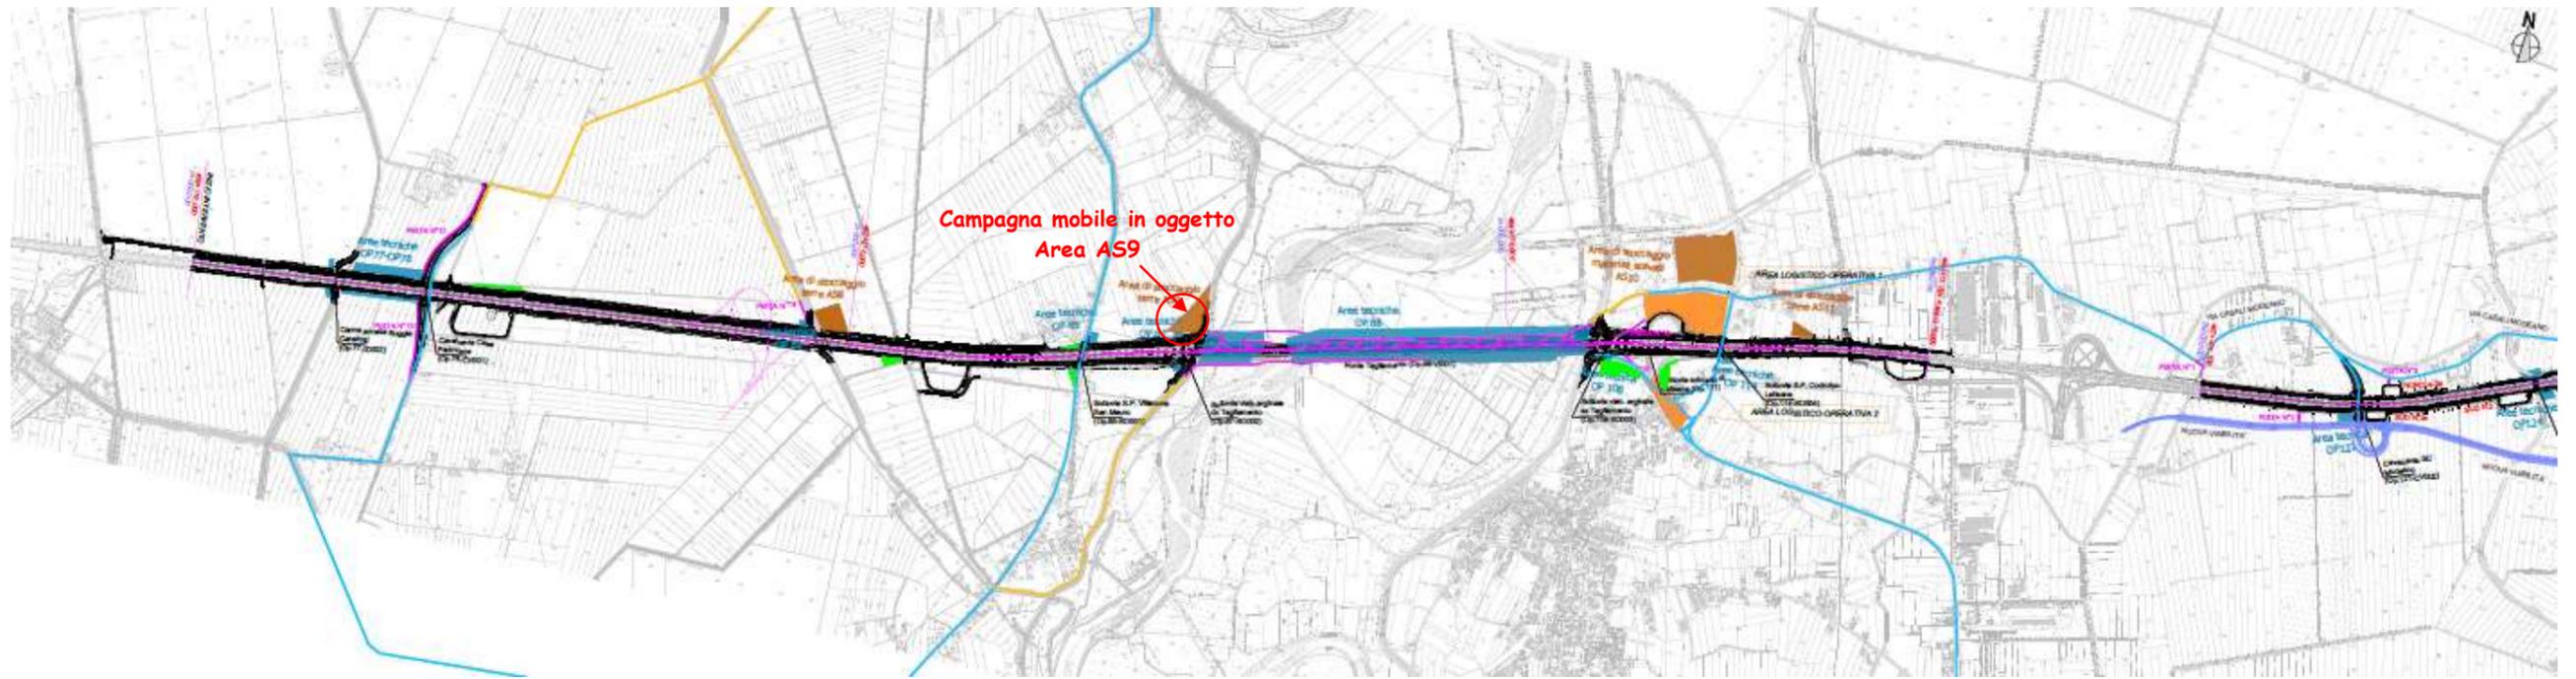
individuazione ubicazione sito oggetto di campagna mobile di trattamento su planimetria di progetto cantiere e piste
